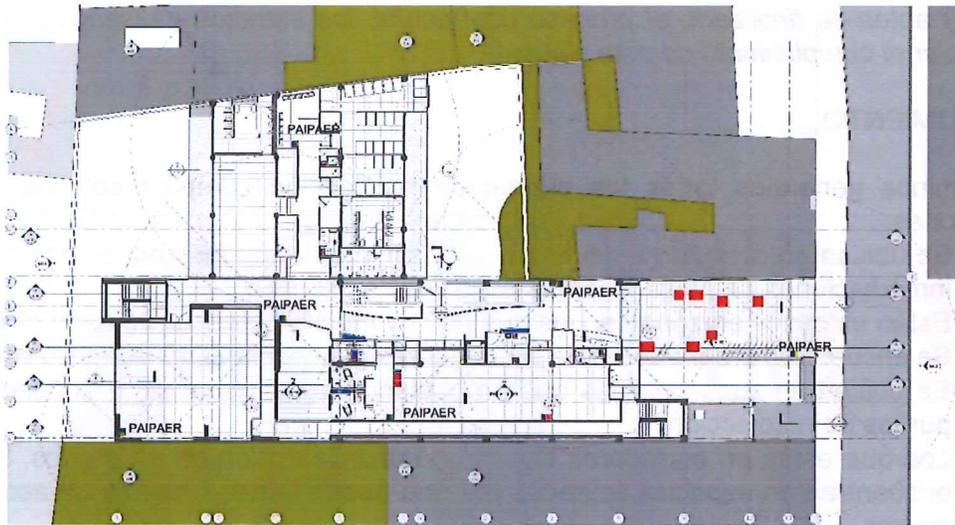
Imagen de planta nivel +0.22 – localización PAIPAERS (anexo No. 7).
